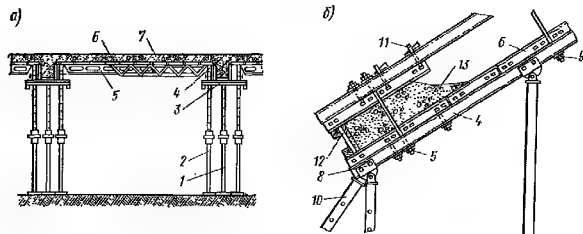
Установка опалубки перекрытий и наклонных поверхностей:
